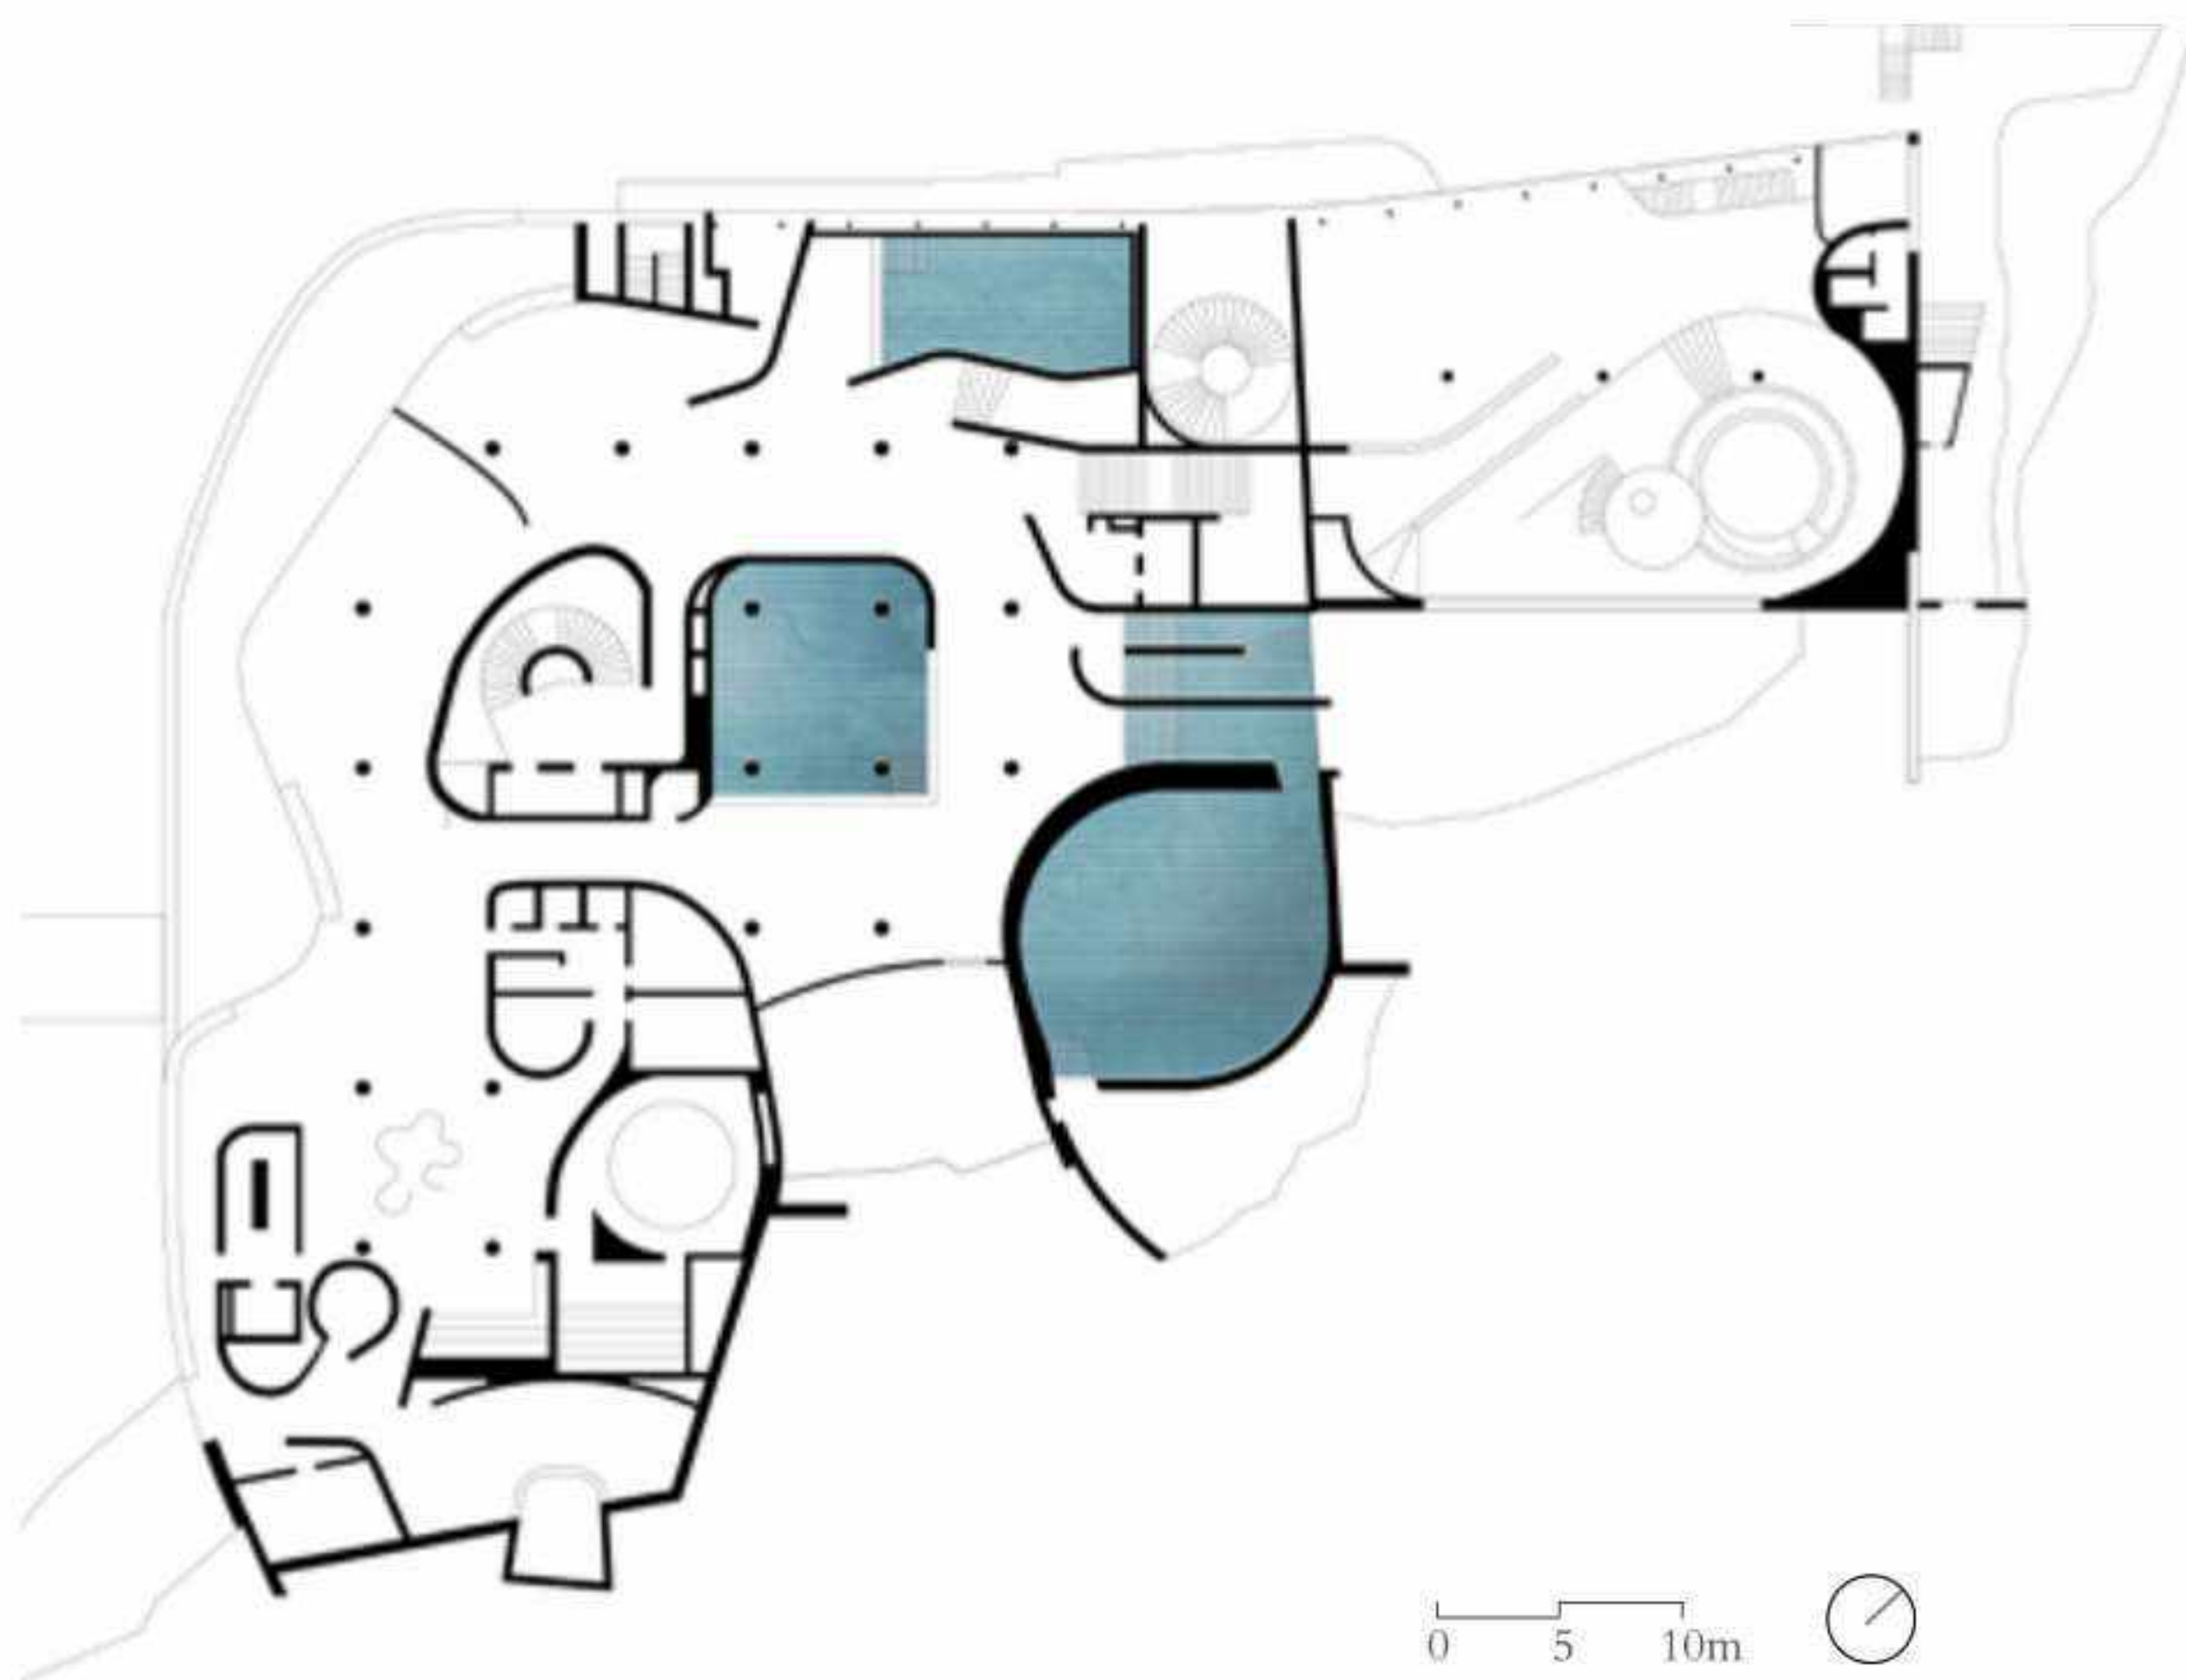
Terme di Tiberio*, pianta primo piano.
